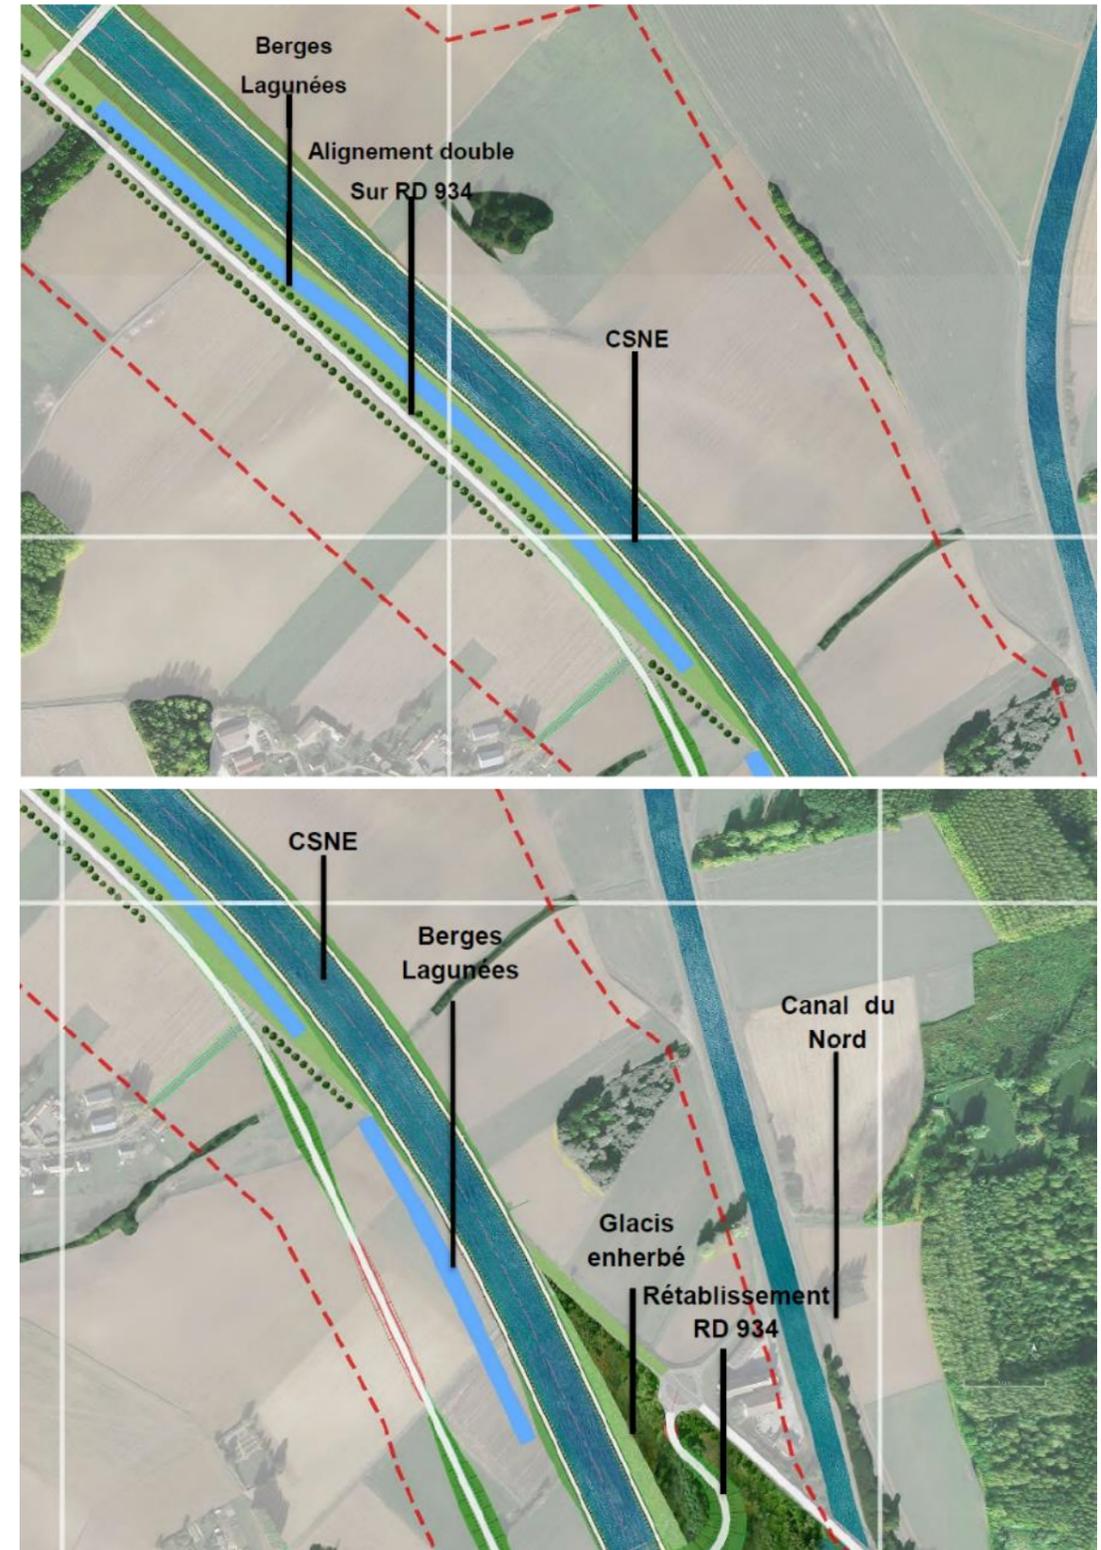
Vues en plan zoomées sur le plan masse paysager le long du CSNE parallèle à la RD934 (source : SDAP secteur 2)
